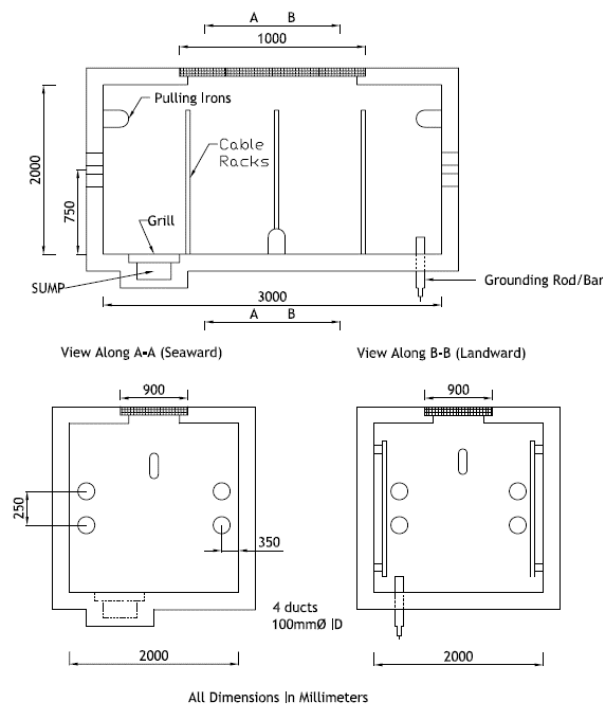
Différentes vues en coupe d'une chambre-plage (Orange)
